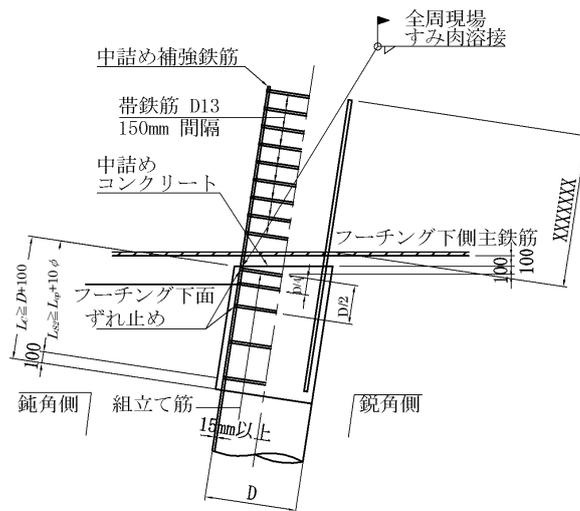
鋼管杭を斜杭として用いるときの接合方法
